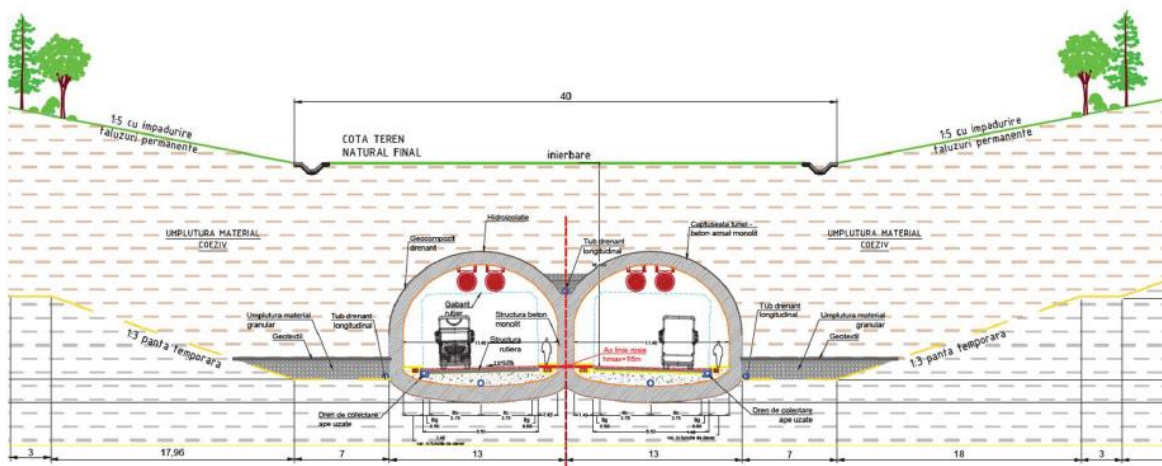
Secțiune transversală Tunel Artificial tip boltă – 2 benzi/sens (PTT02)
